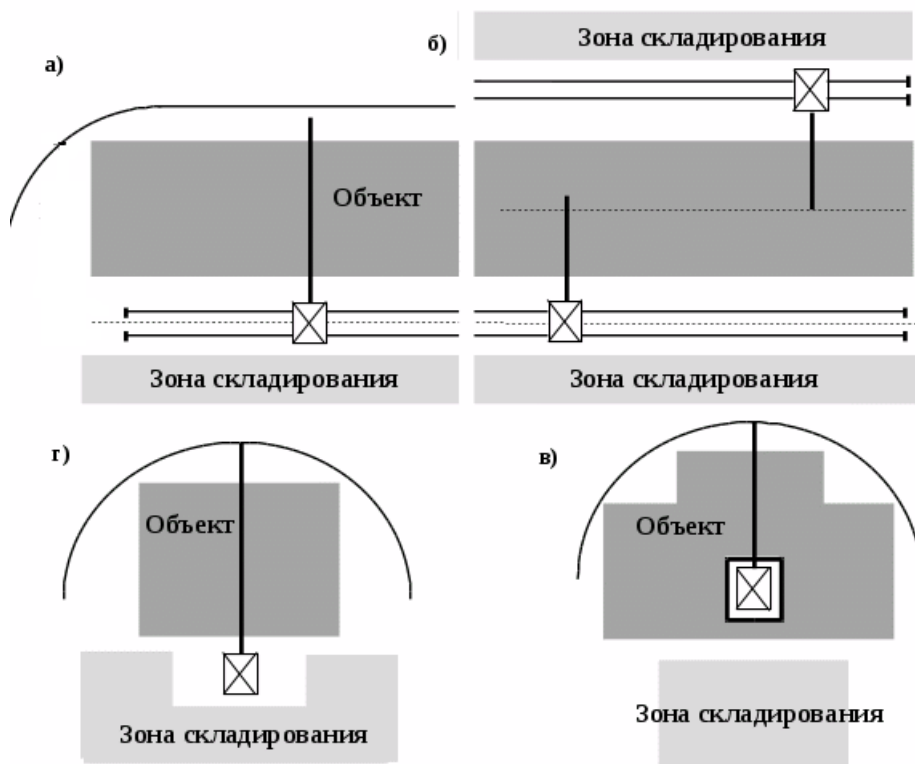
Схемы установки кранов при возведении монолитных зданий стеновой системы:
